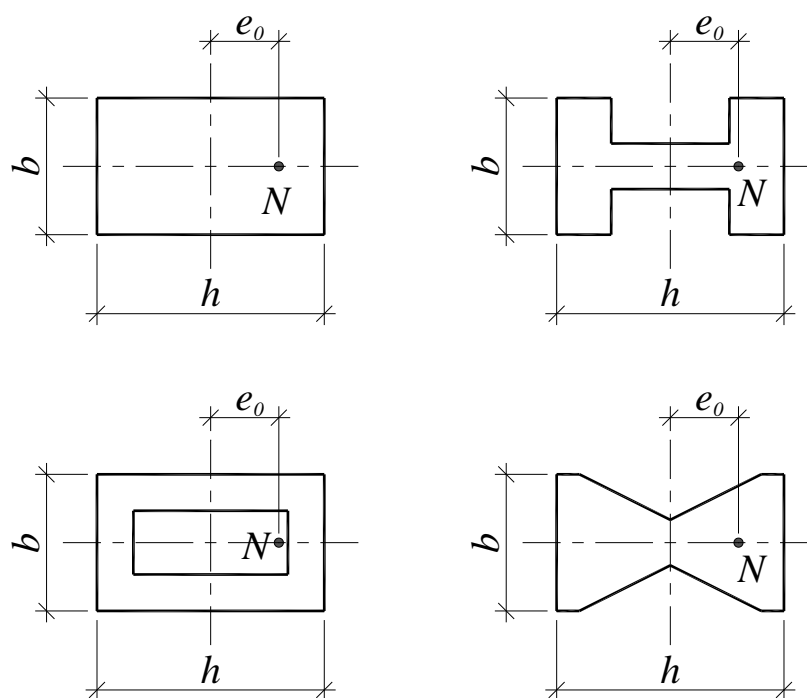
Сечения сжатых железобетонных элементов при эксцентриситетах  $e_0 > e_a$ .
